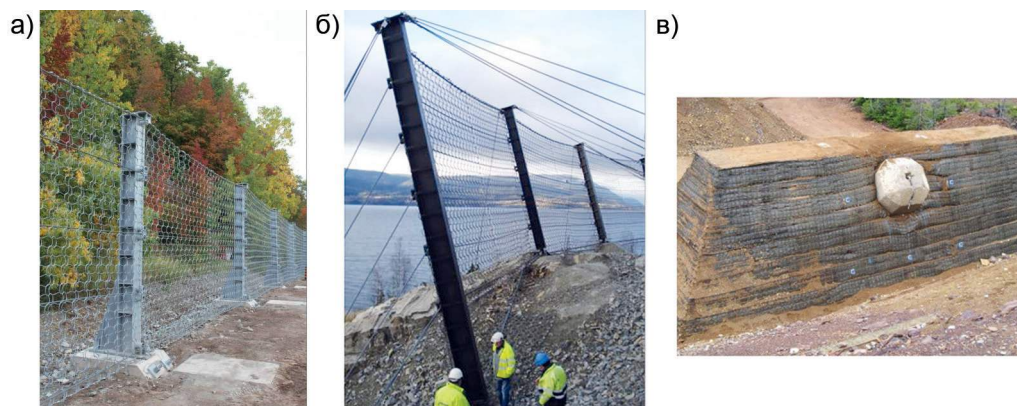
Типовые конструкции улавливающих барьеров: негнущийся барьер (а); динамический барьер (б); предохранительный вал (в)
